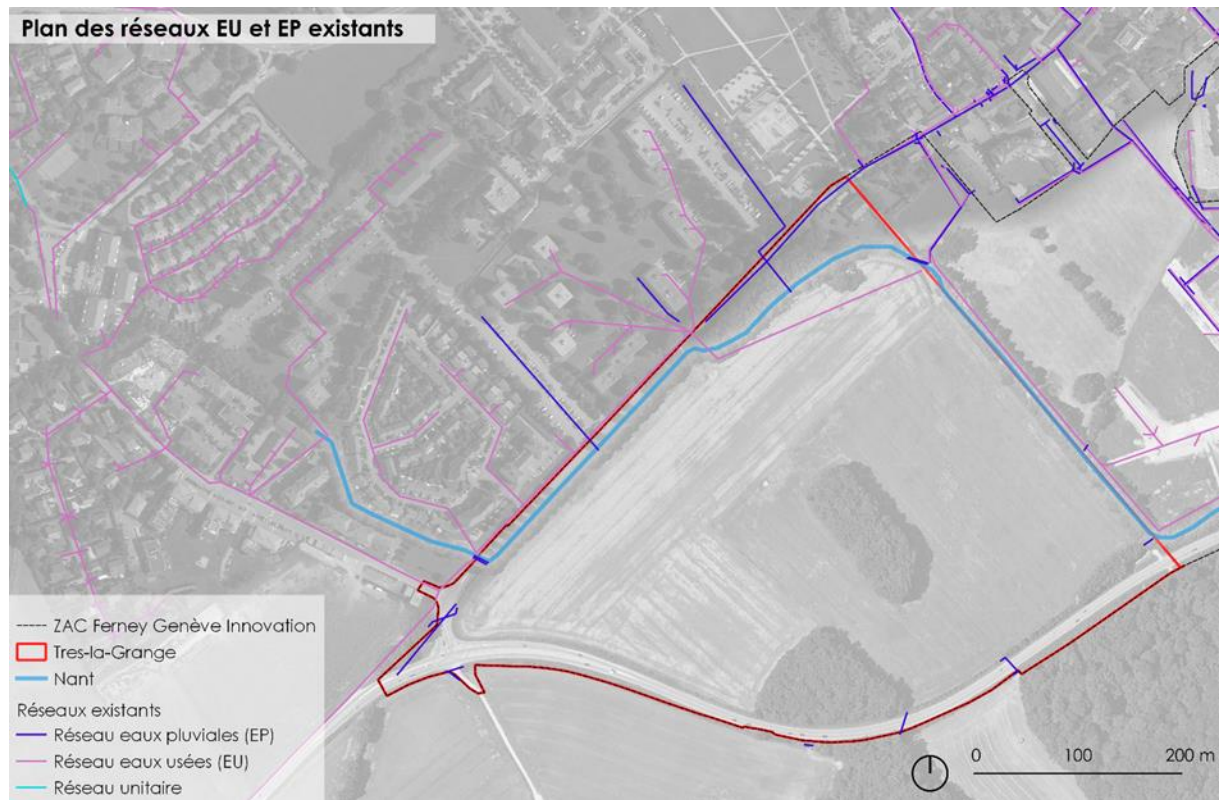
Réseaux d'assainissement eaux usées et eaux pluviales sur le secteur de Très-la-Grange, ALTO STEP, 2022
